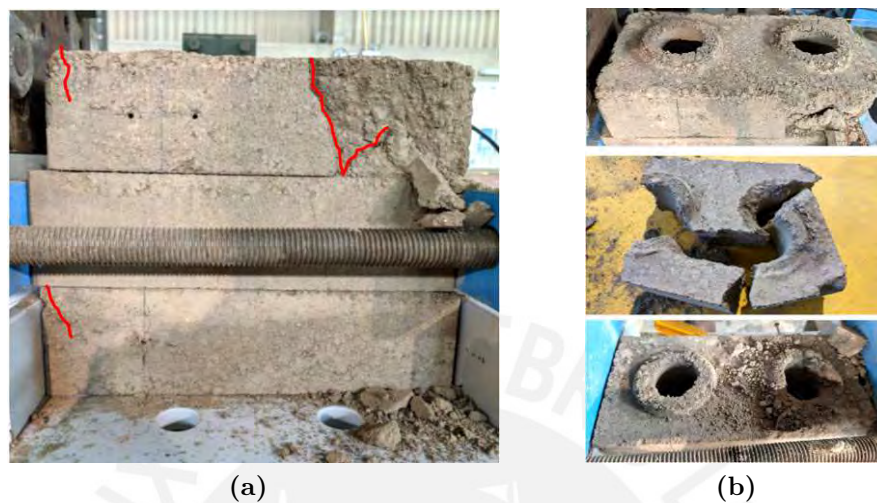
Patrones de falla en pila P0 bajo un esfuerzo de precompresión de 0.15 MPa: (a) grietas en la vista frontal de la pila y (b) fallas generadas en las unidades.
